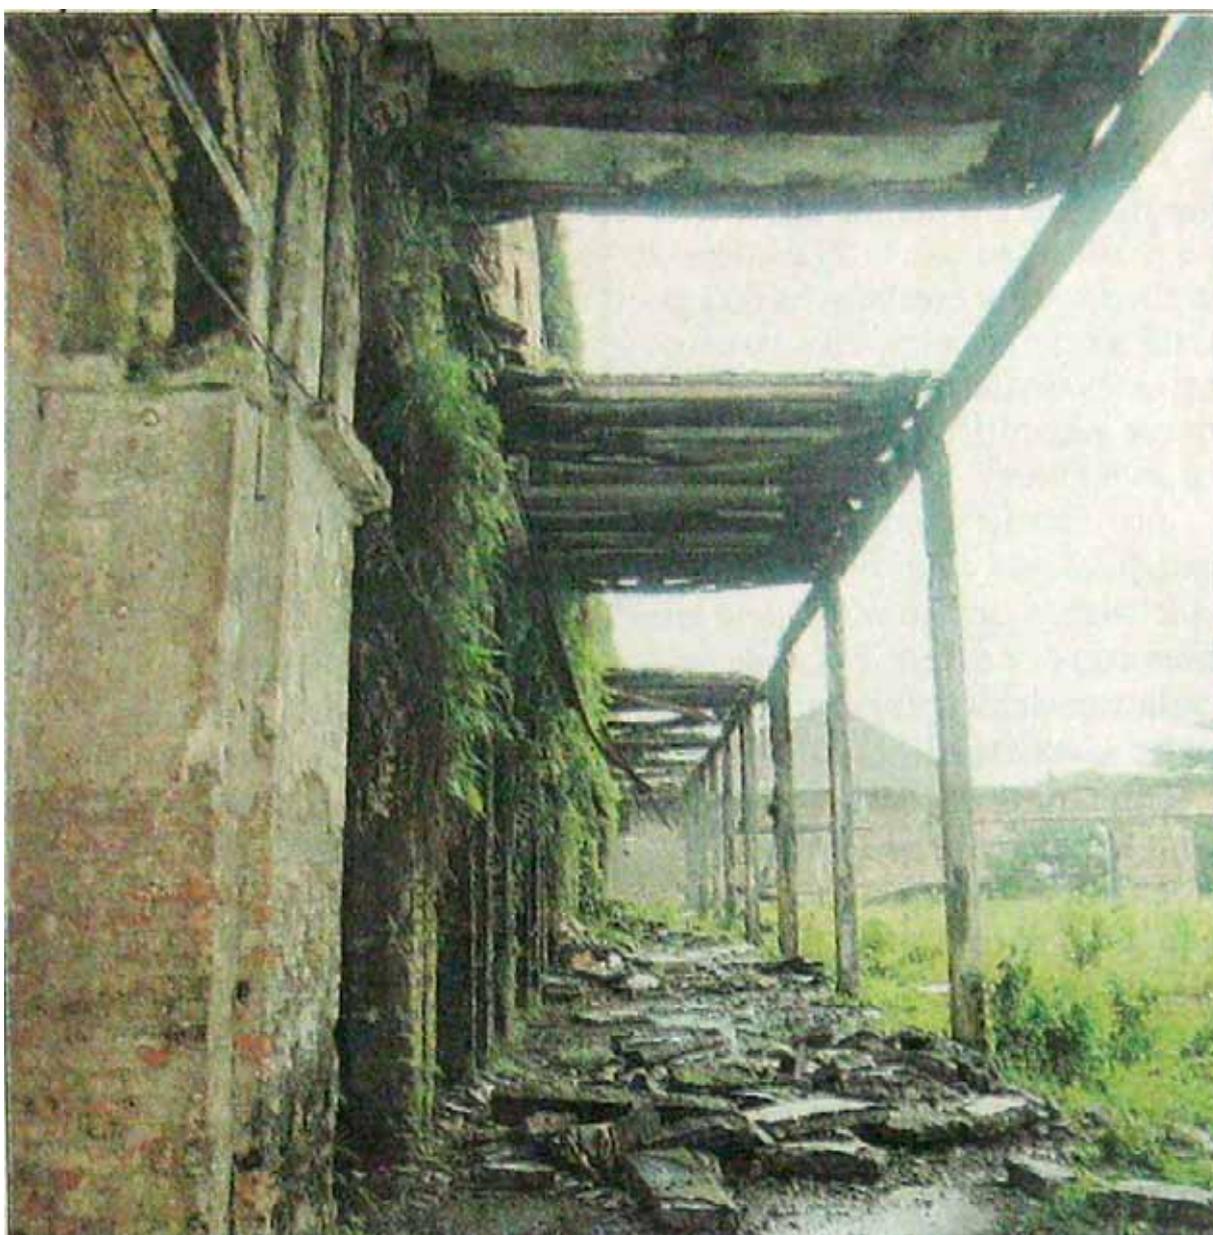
Vista da laje do pátio central - desabamento parcial desta laje ocorreu em dezembro de 2003
